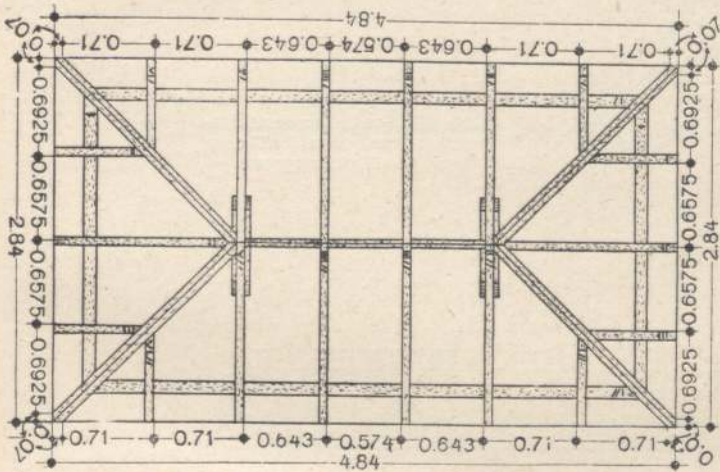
Die Sparrenlage zu der Dachausmittlung in Abb. 1103.
